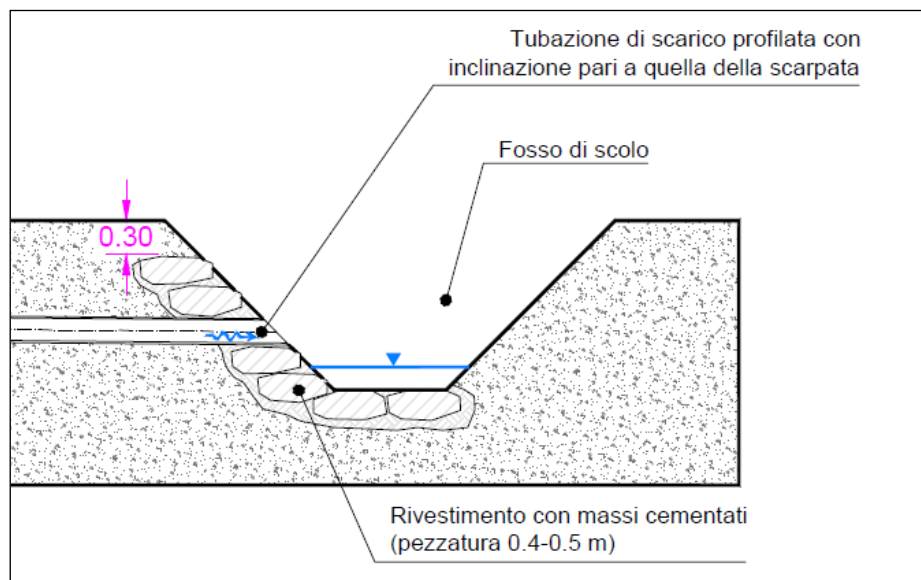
Vista laterale dell'immissione del tubo di scarico nel canale ricevente.
